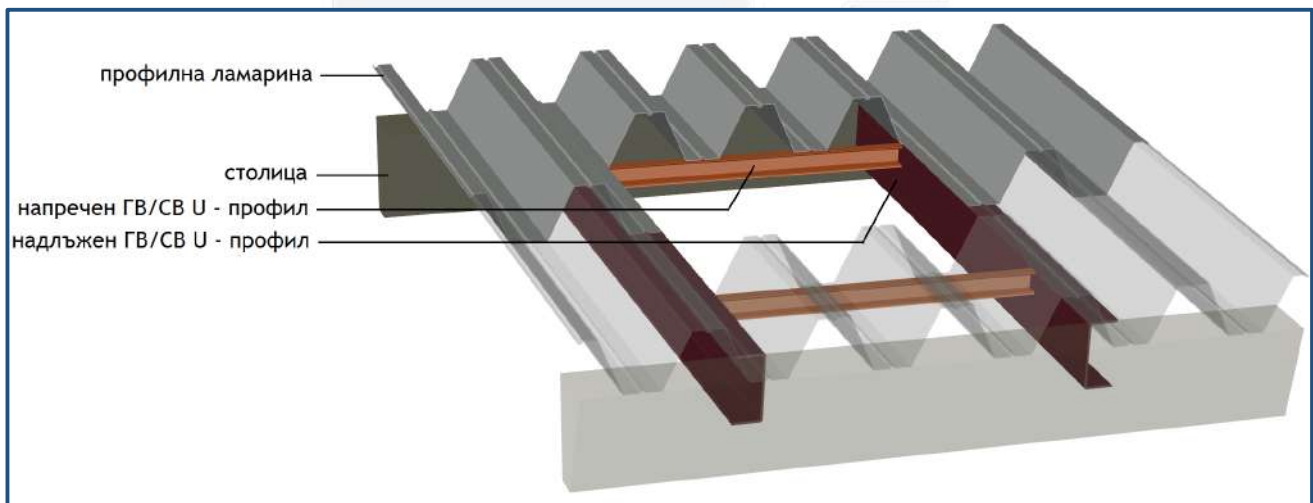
Схеми на укрепване тип - горно, след ламарина
